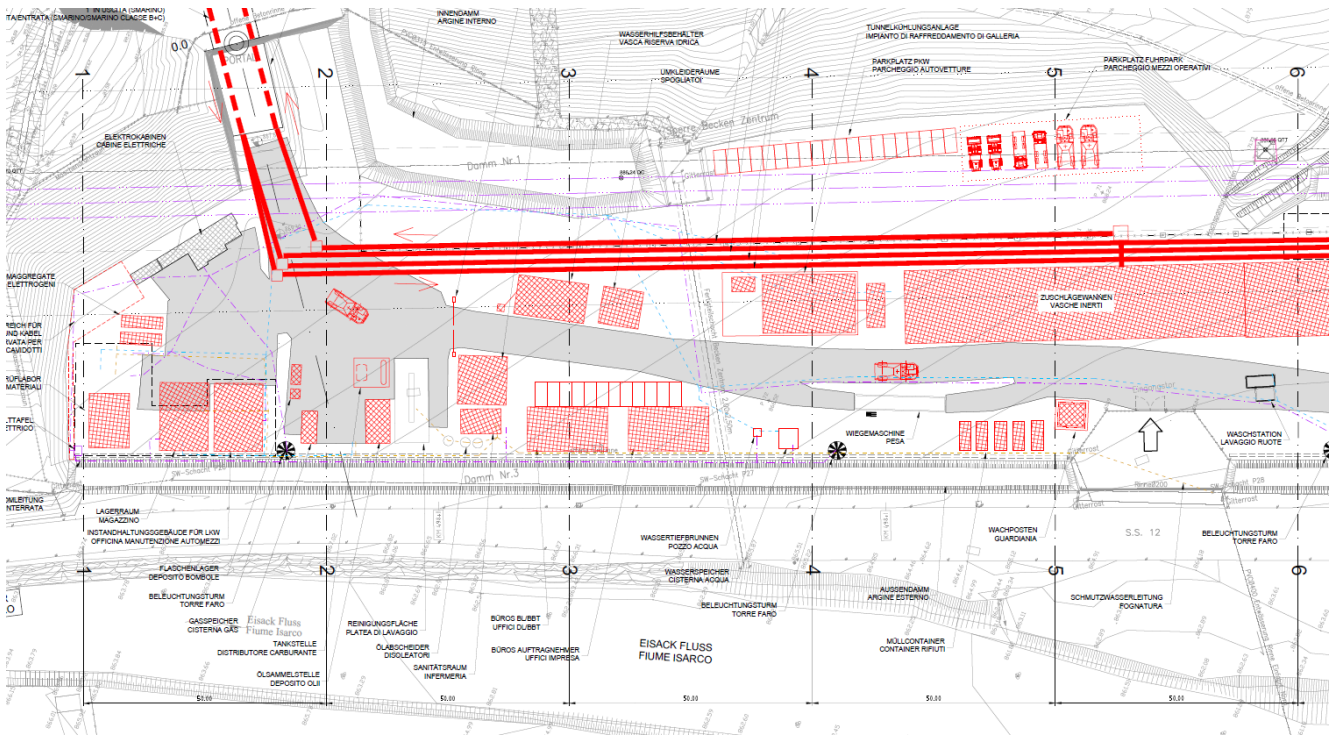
Baustelle Muls: Lageplan Fläche Nr. 1 Nord
